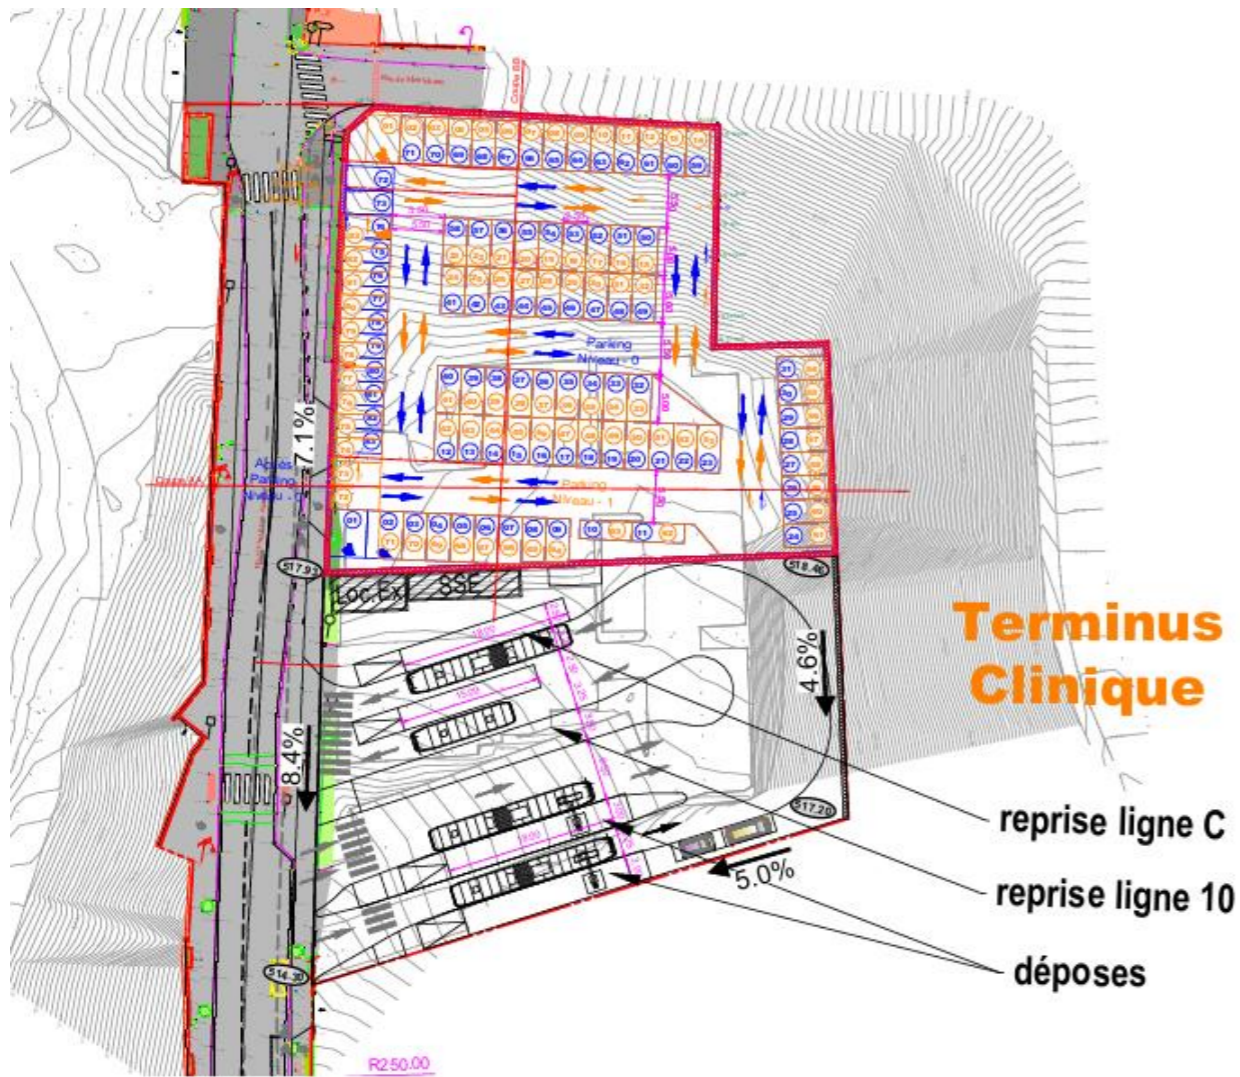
Plan d'implantation du terminus à Durtol et de la reconstitution des places de stationnement envisagé au stade des études préliminaires.
